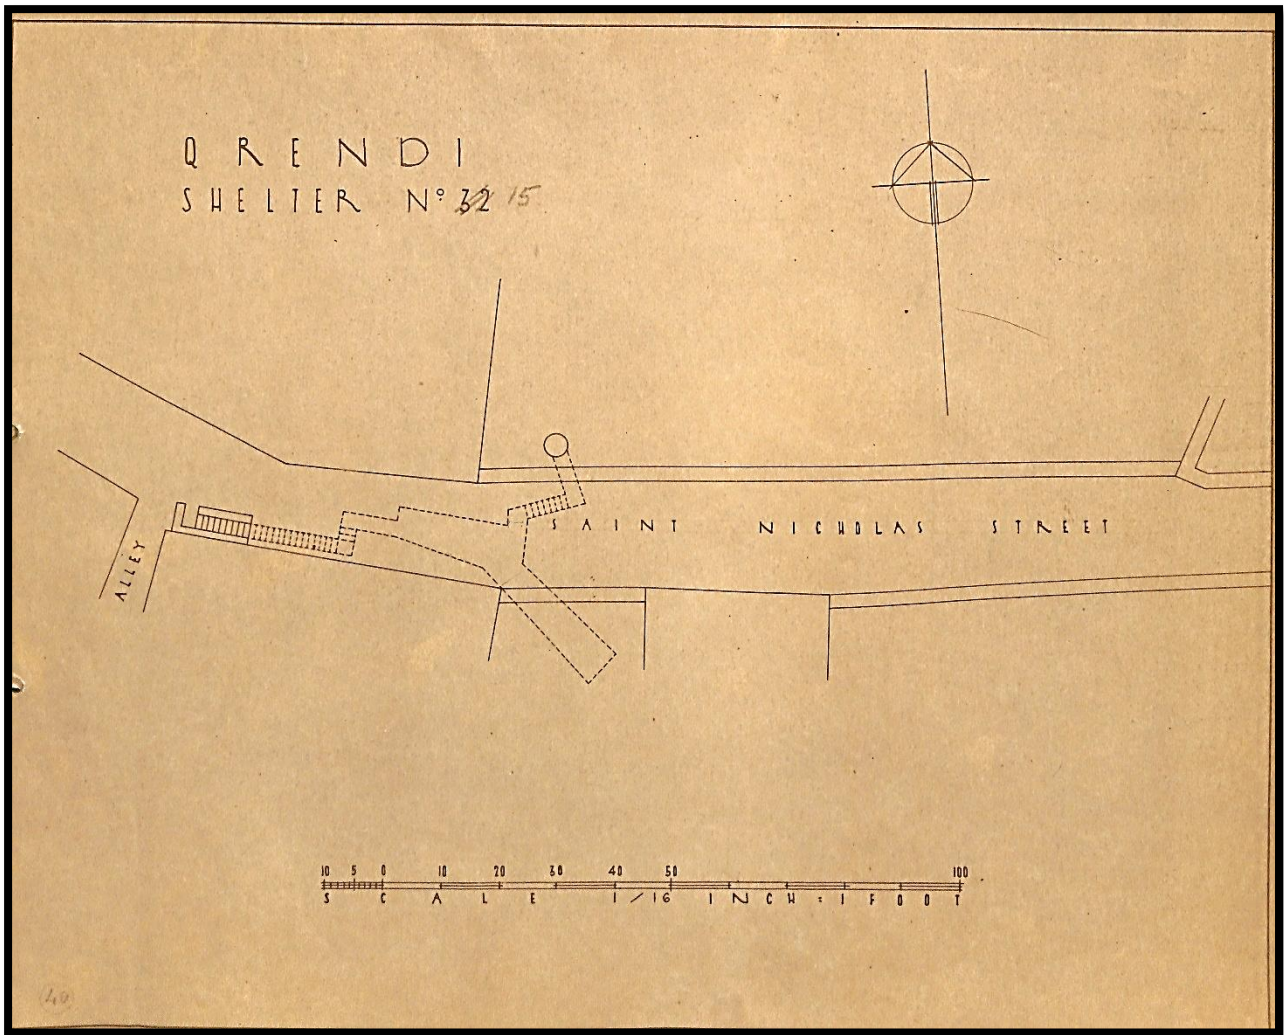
Planta do Abrigo nº15 "Saint Nicholas Street - Alley."
